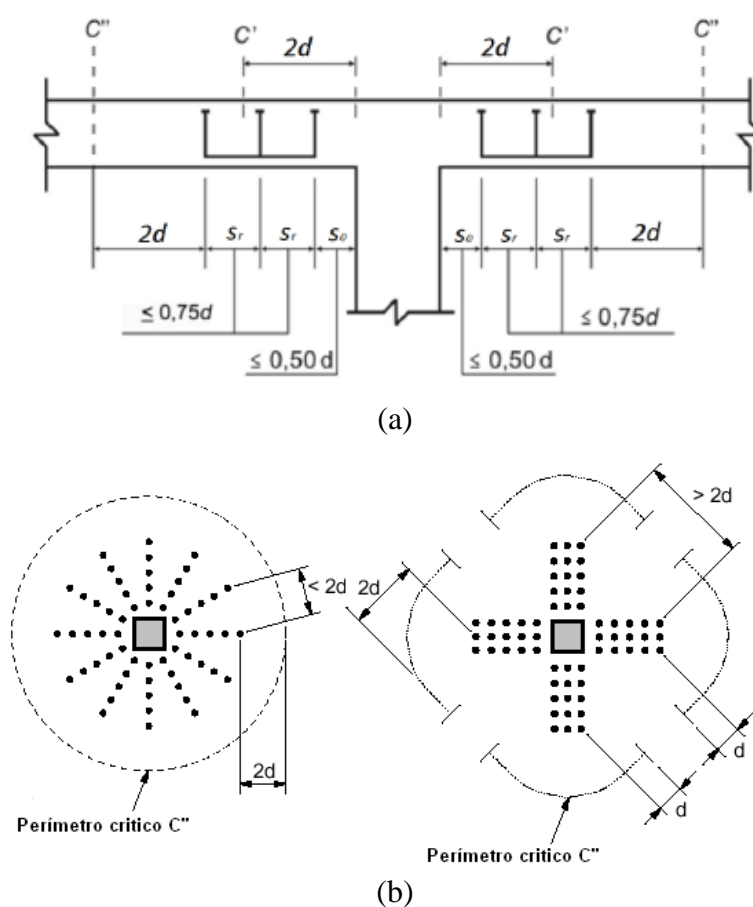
a) Disposição da armadura de punção em corte; b) Disposição de armaduras de punção em planta e contornos de superfície crítica C''
